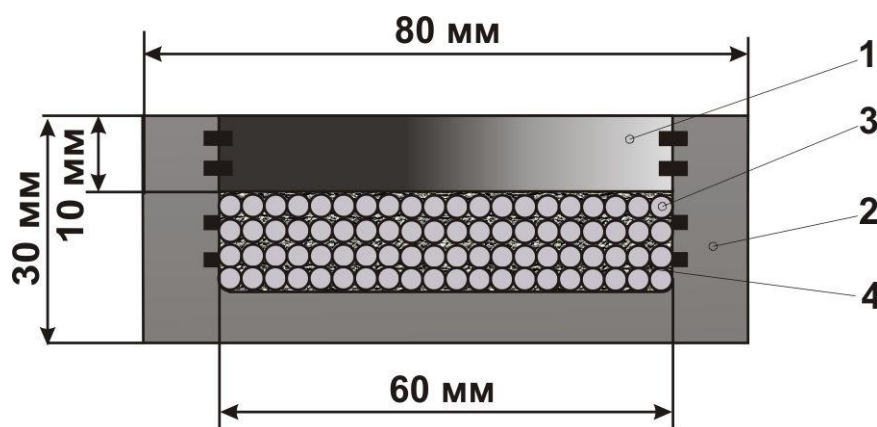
Конструкция рельса-струны городского среднего моноСТЮ (масштаб 1:1); 1 — головка рельса из высокопрочного алюминиевого сплава (1,71 кг/м); 2 — корпус из высокопрочного алюминиевого сплава (3,08 кг/м); 3 — стальная проволока диаметром 3 мм (струна), 80 проволок (4,44 кг/м); 4 — композит-герметик (0,31 кг/м). Масса рельса-струны — 9,54 кг/м. Масса контактного провода и изоляторов (на рисунке не показаны) — 1,2 кг/м.
